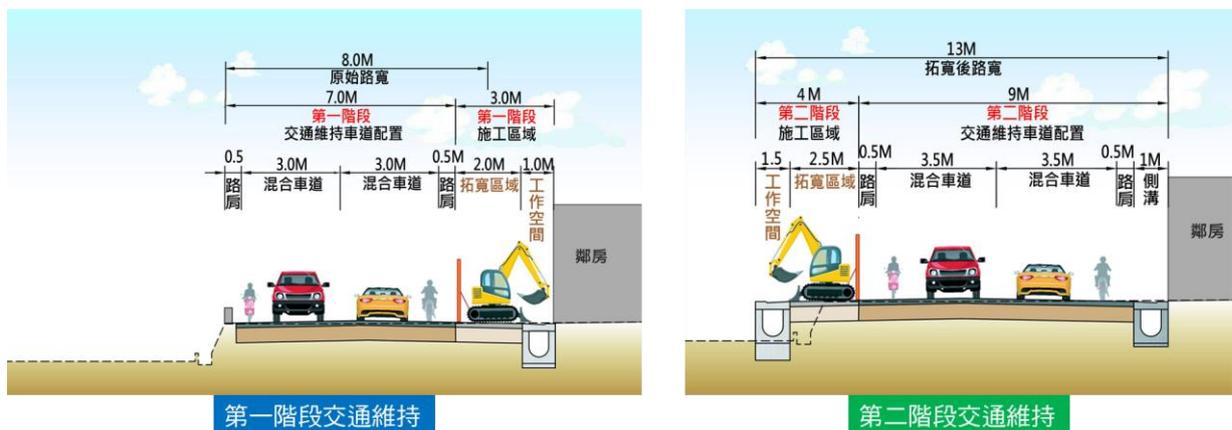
兩階段半半施工交通維持橫斷面示意圖
